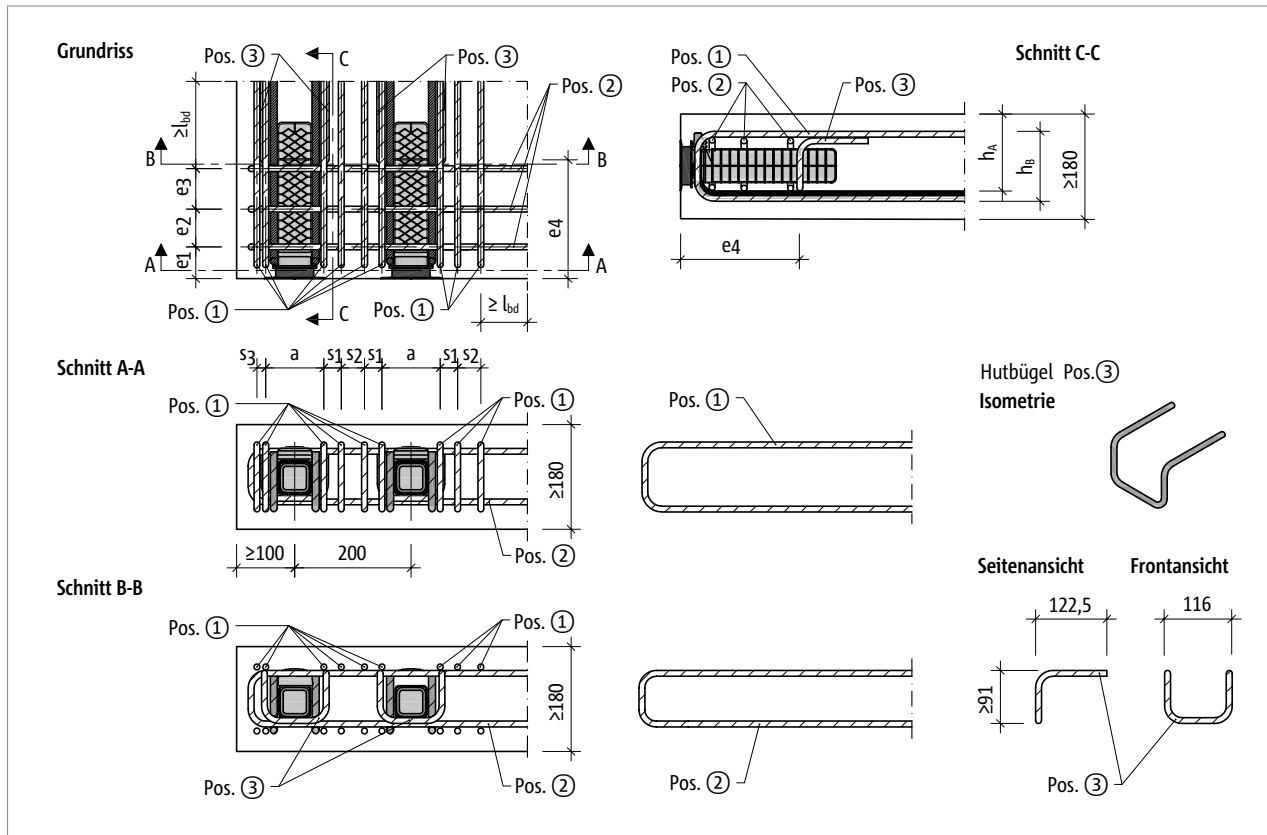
Schöck Tronsole® Typ P: Bauseitige Bewehrung für die paarweise Anordnung
